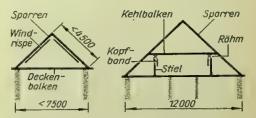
Sparrendach (links) und Kehlbalkendach mit doppelt stehendem Stuhl (rechts)
